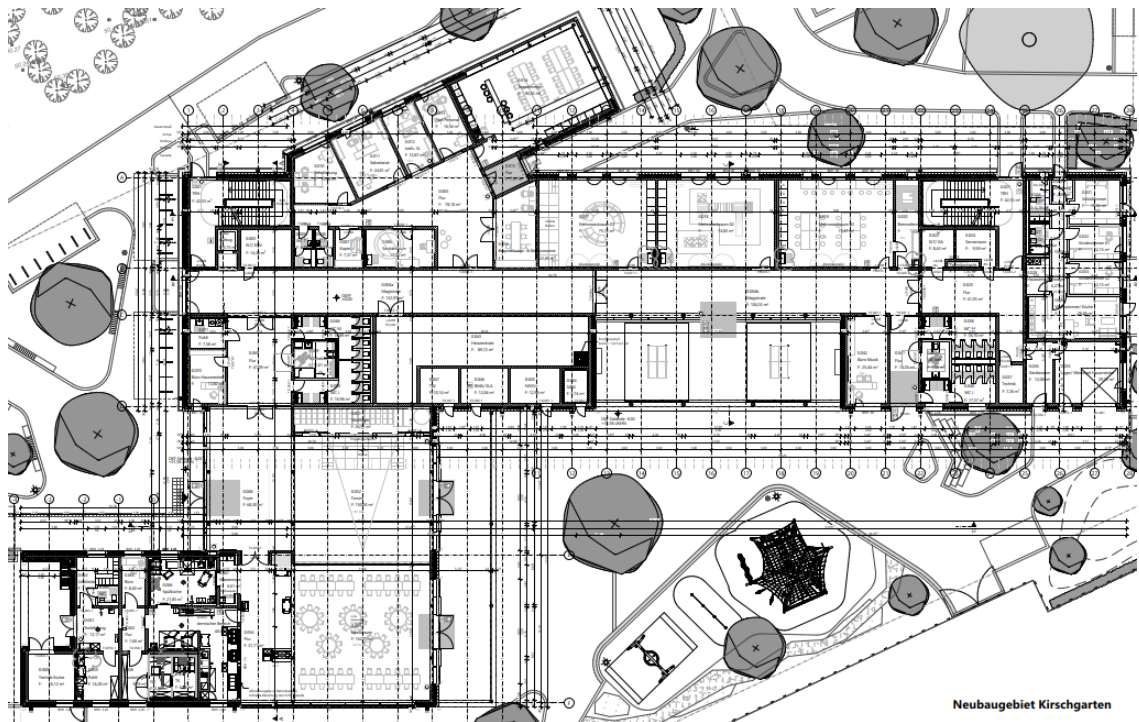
Grundrissausschnitt EG) /i/
